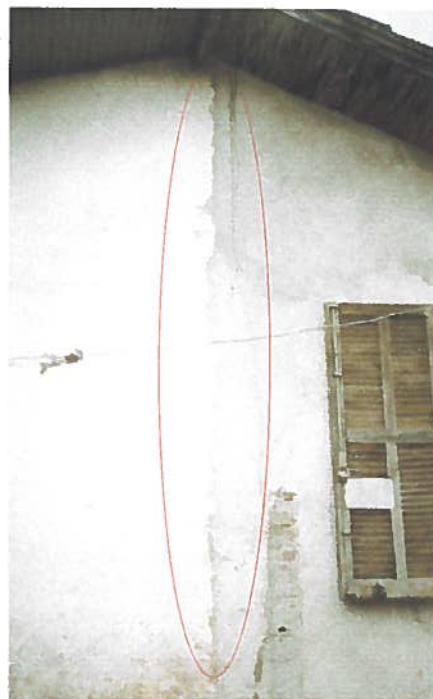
Habitação 09: elevação posterior (emenda entre a parte original e a parte ampliada pelo morador).
